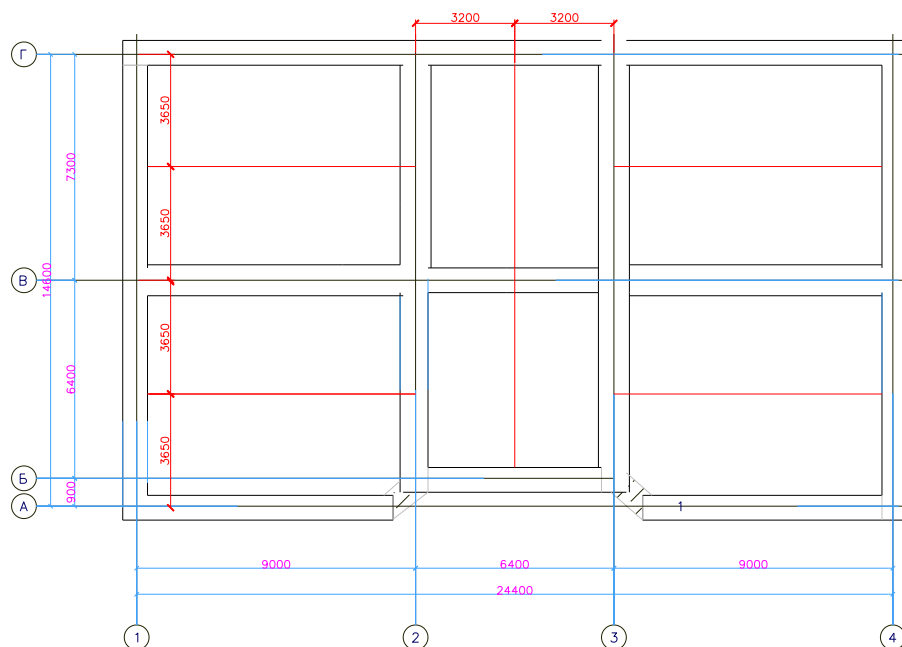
Расчетные длины при сборе нагрузок на фундаментную ленту
